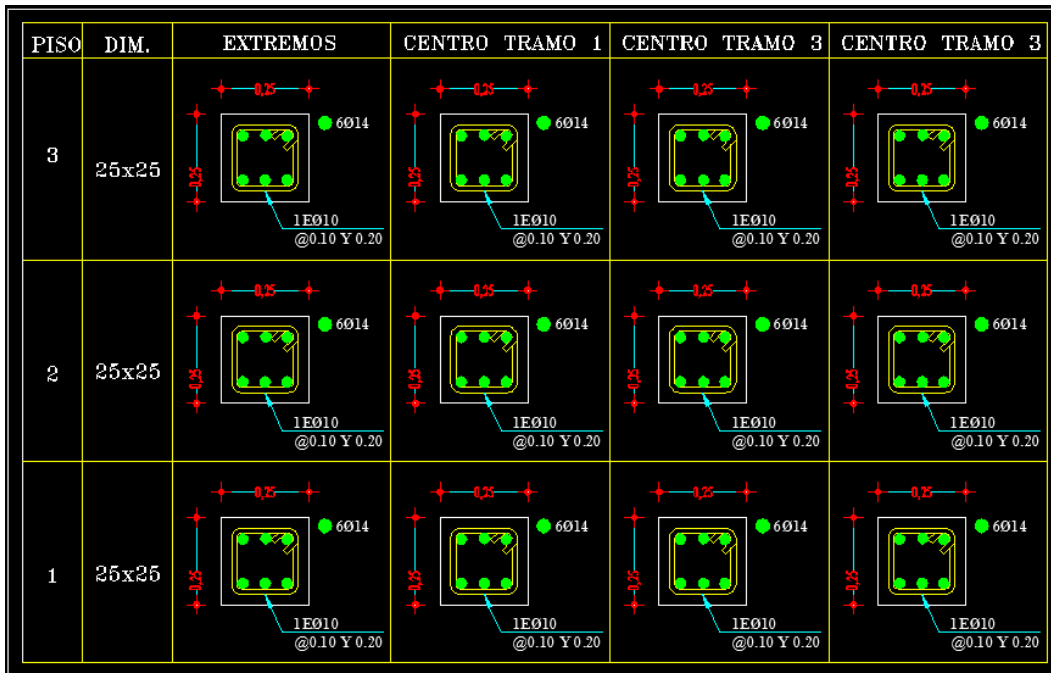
Armadura de las Vigas Edifi. 3 Pisos
